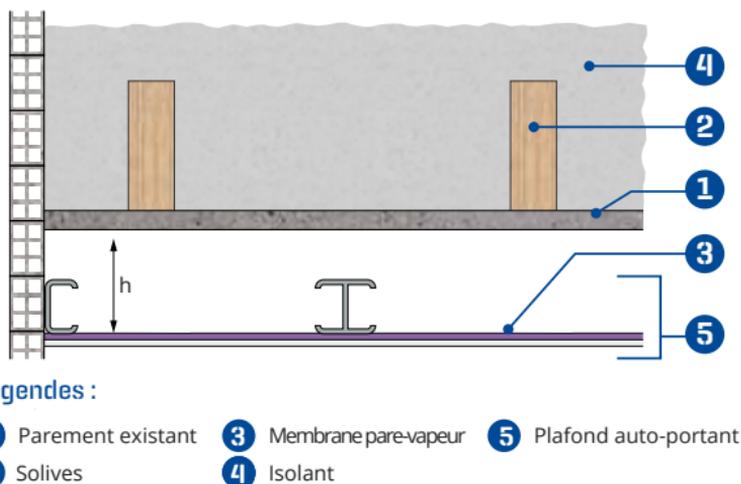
Membrane sur la plaque de plâtre d'un plafond auto-porté
